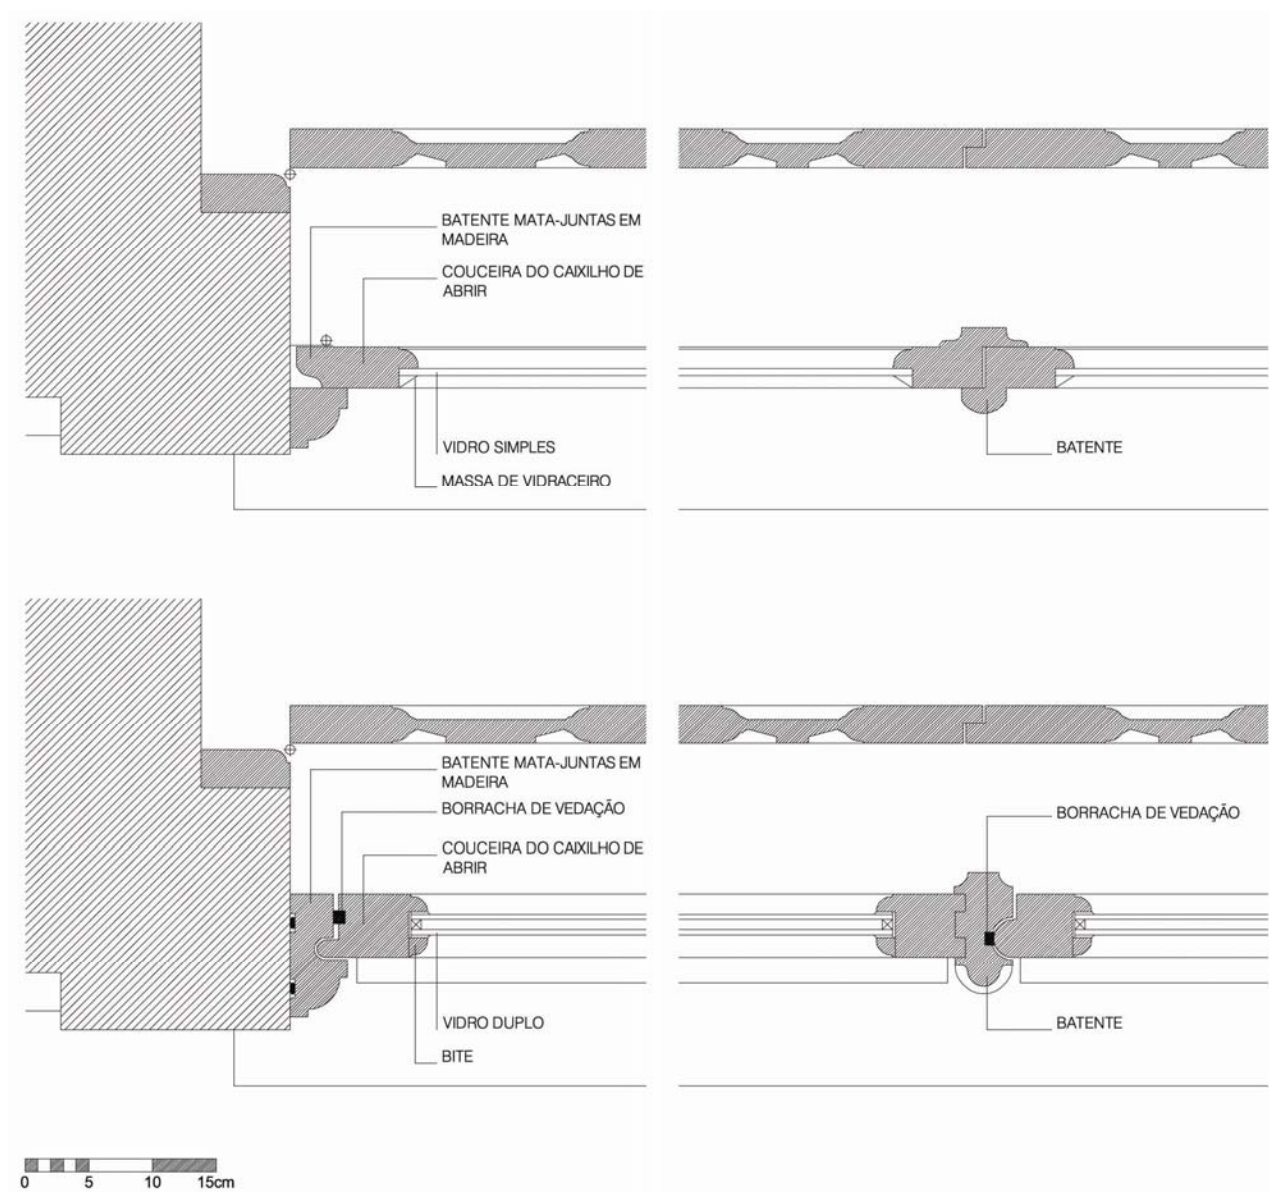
Substituição da caixilharia existente por uma nova caixilharia (re) interpretando o desenho original - pormenores dos cortes horizontais da caixilharia existente e da caixilharia proposta
